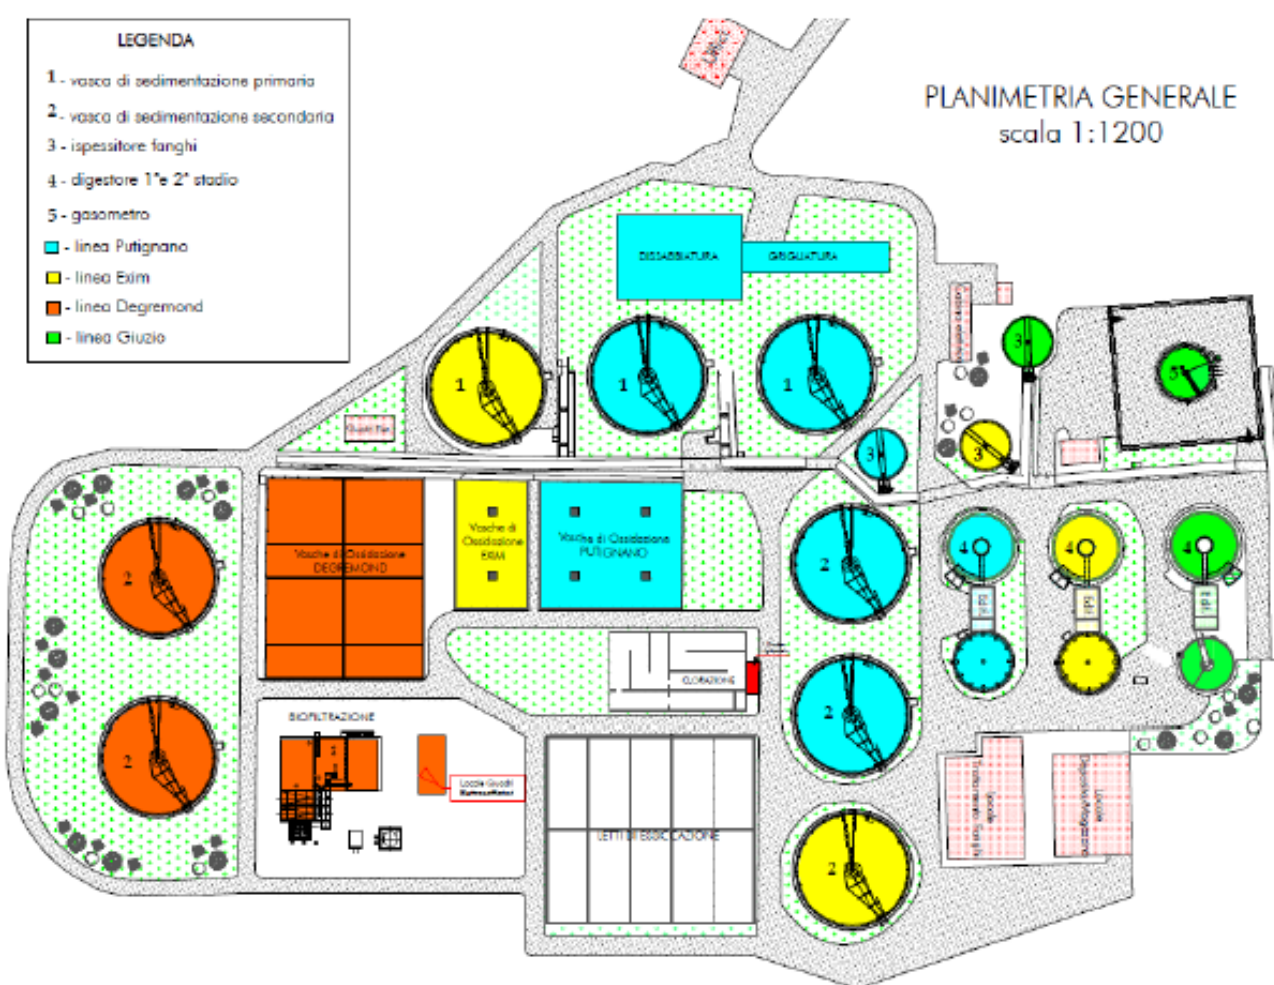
Stralcio della planimetria dell'impianto di depurazione comprensoriale del Partenio e dell'Alta Valle del Sabato (fonte: documentazione progettuale)
